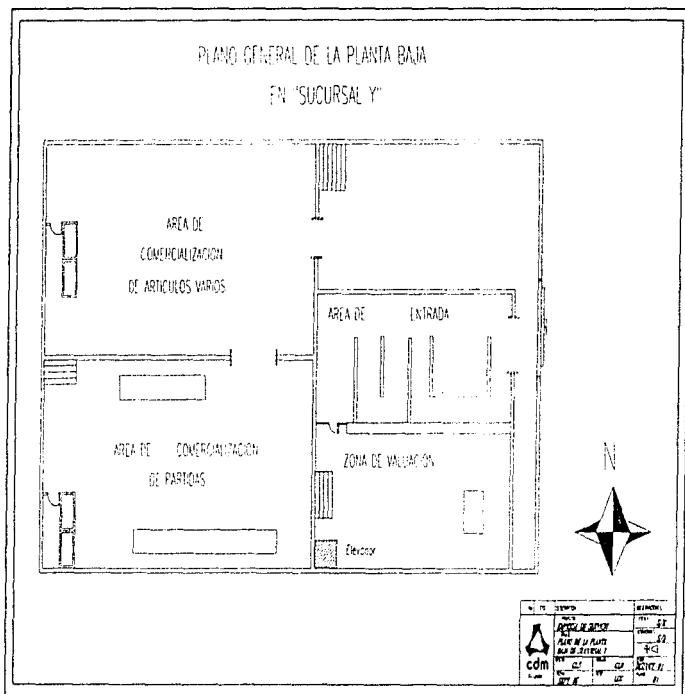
Distribución de la planta baja en la "Sucursal Y".
